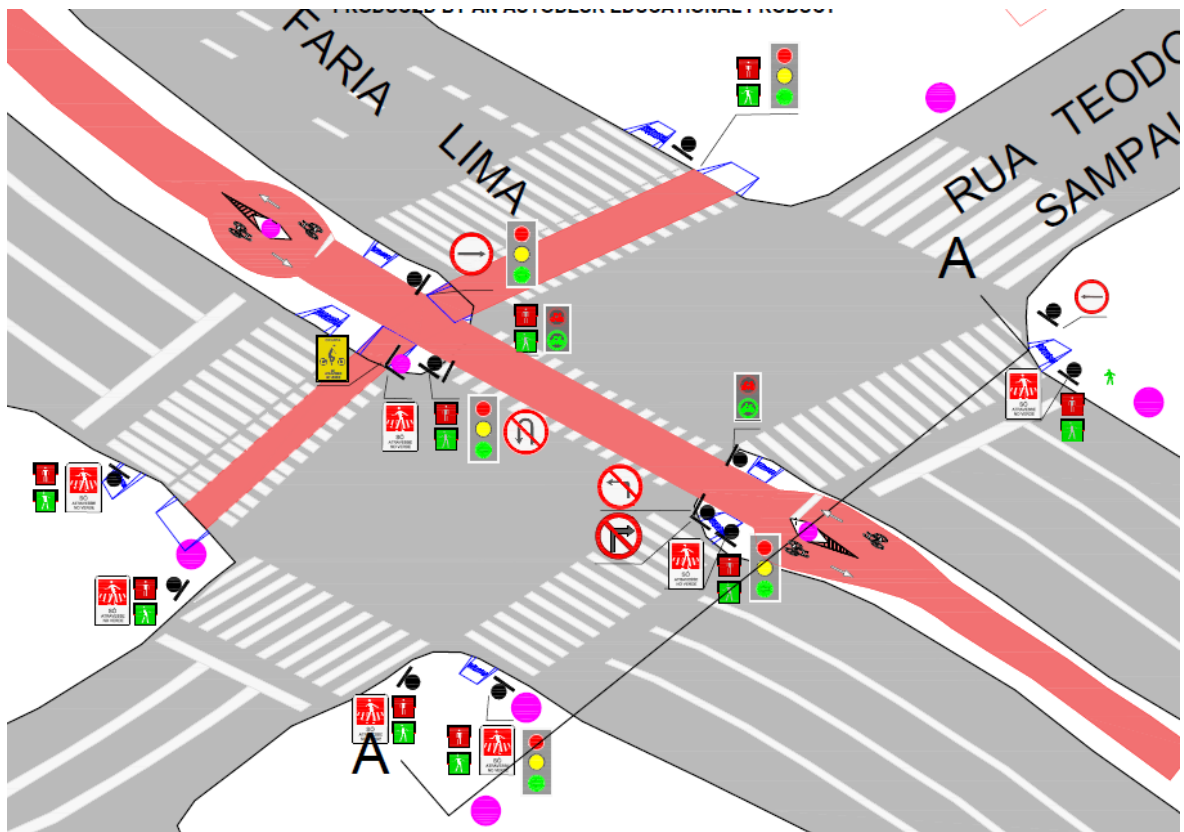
Proposta de modificação cruzamento Av. Faria Lima com Rua Teodora Sampaio.
